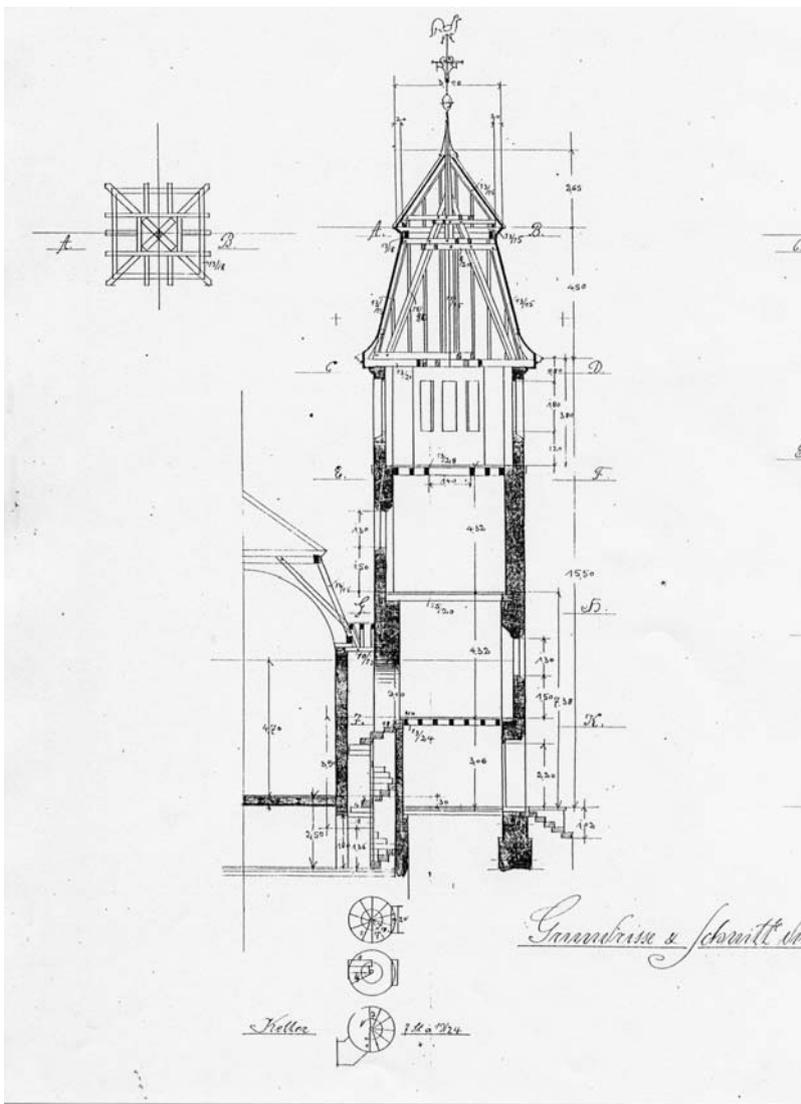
H. Plange, Neanderkirche, Grundriss und Schnitt durch den Turm, 1903
